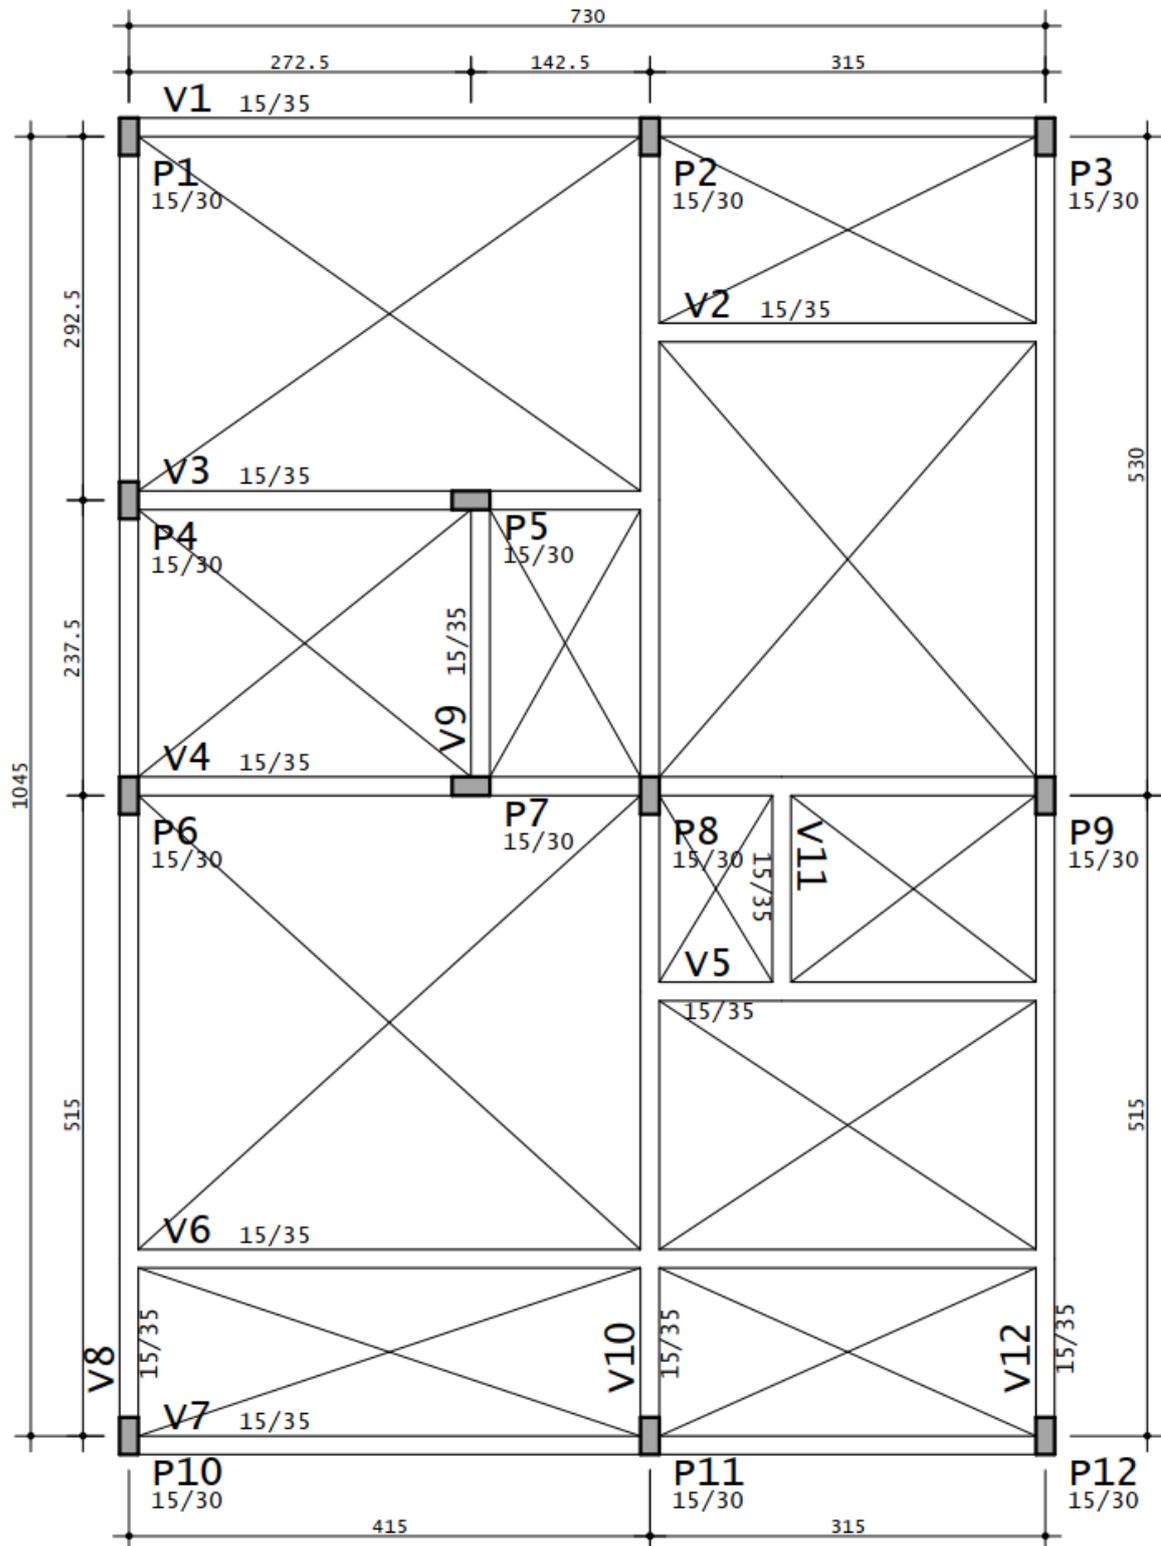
Planta de forma do pavimento superior da estrutura moldada no local (+3,00)
